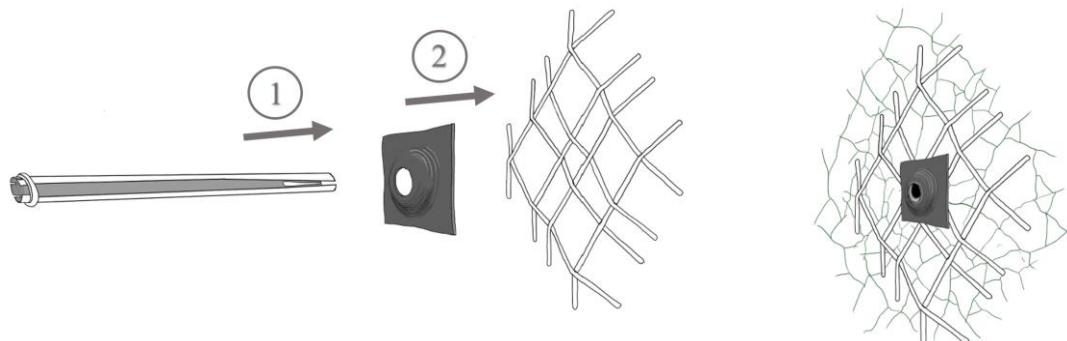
Схема установка анкерной крепи ФА с армокаркасом
